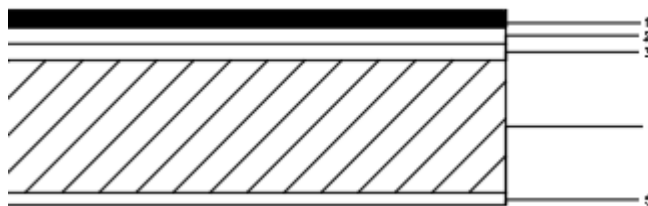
Coupe transversale de la dalle pleine du plancher haut du sous-sol.
